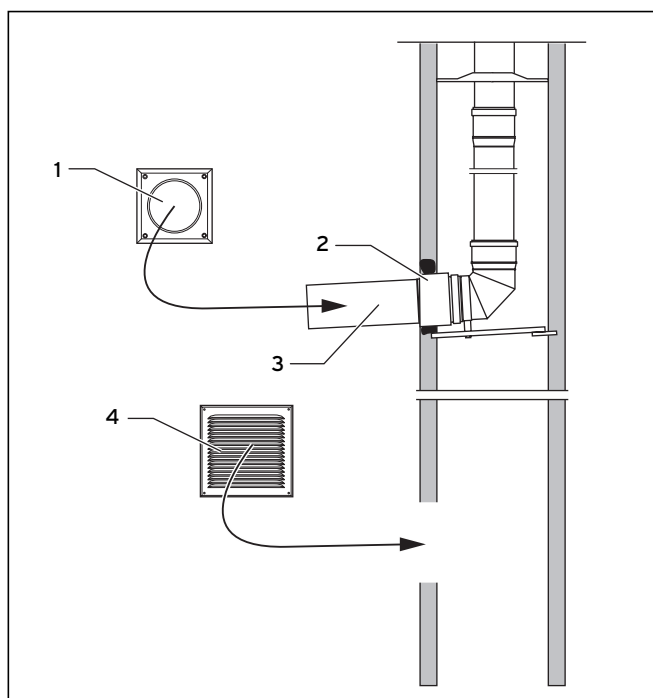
Montaggio tubo scarico fumi, tubo di protezione, diaframma muro e griglia di aerazione
